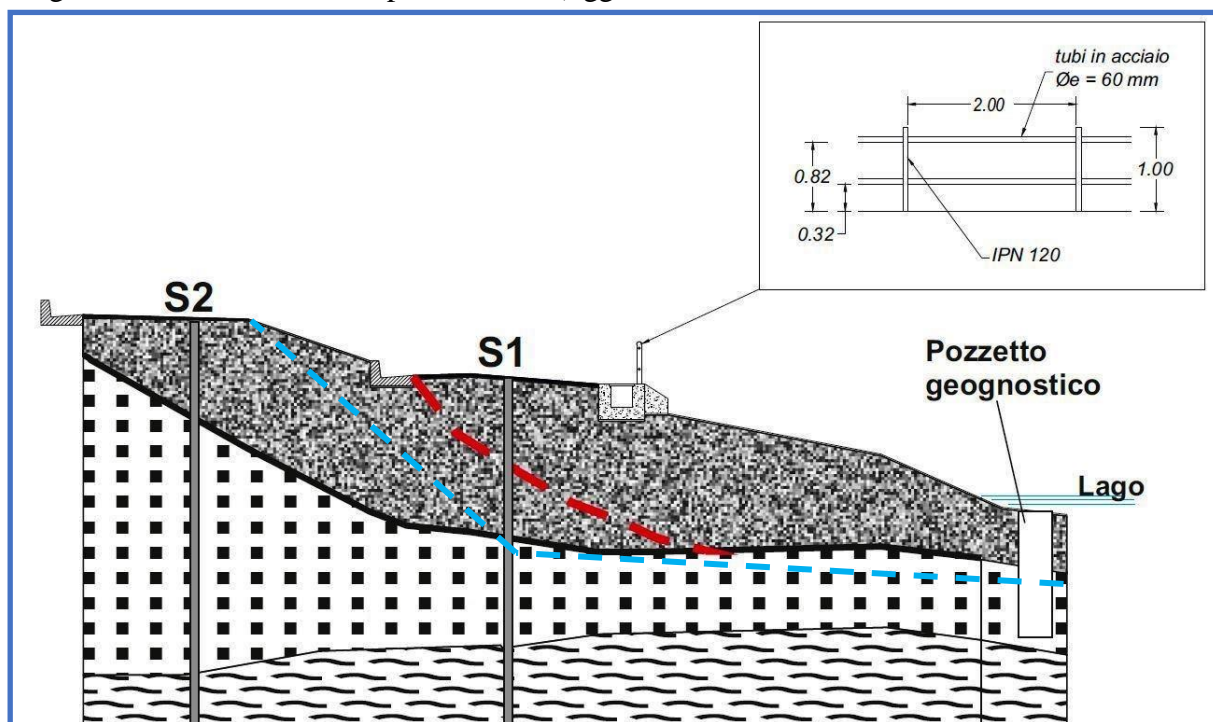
Zona intervento 1 – Indicazione (in celeste) della sezione di scavo necessaria per il rifacimento del rilevato stradale (seconda soluzione prevista nel Progetto di Fattibilità)
